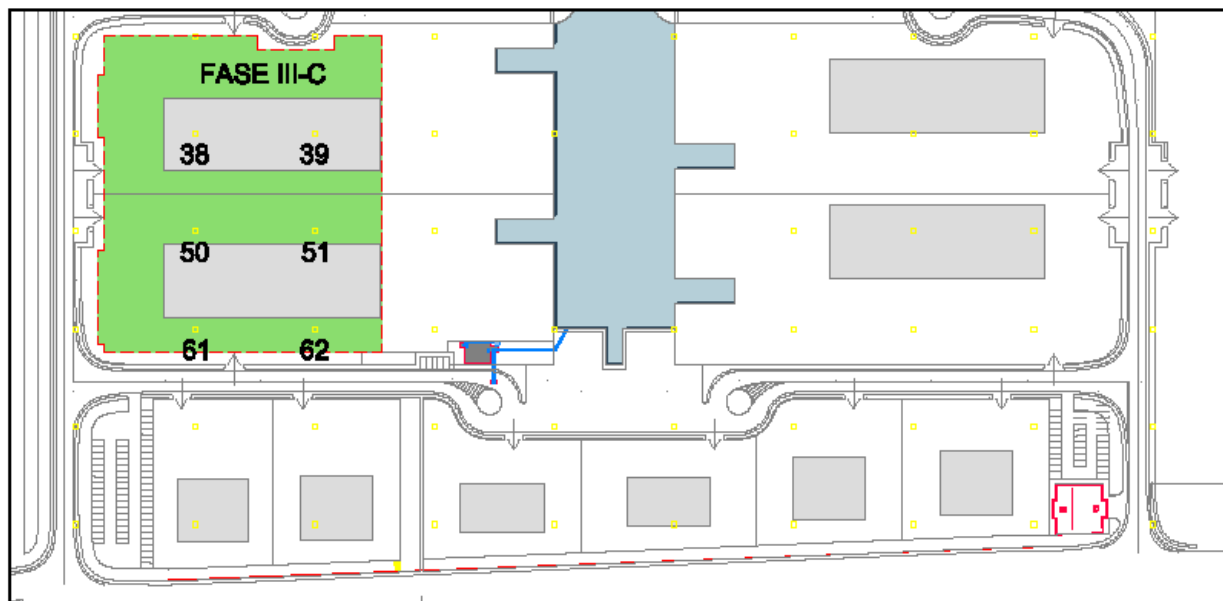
Planimetria delle stazioni di monitoraggio di FASE III.
